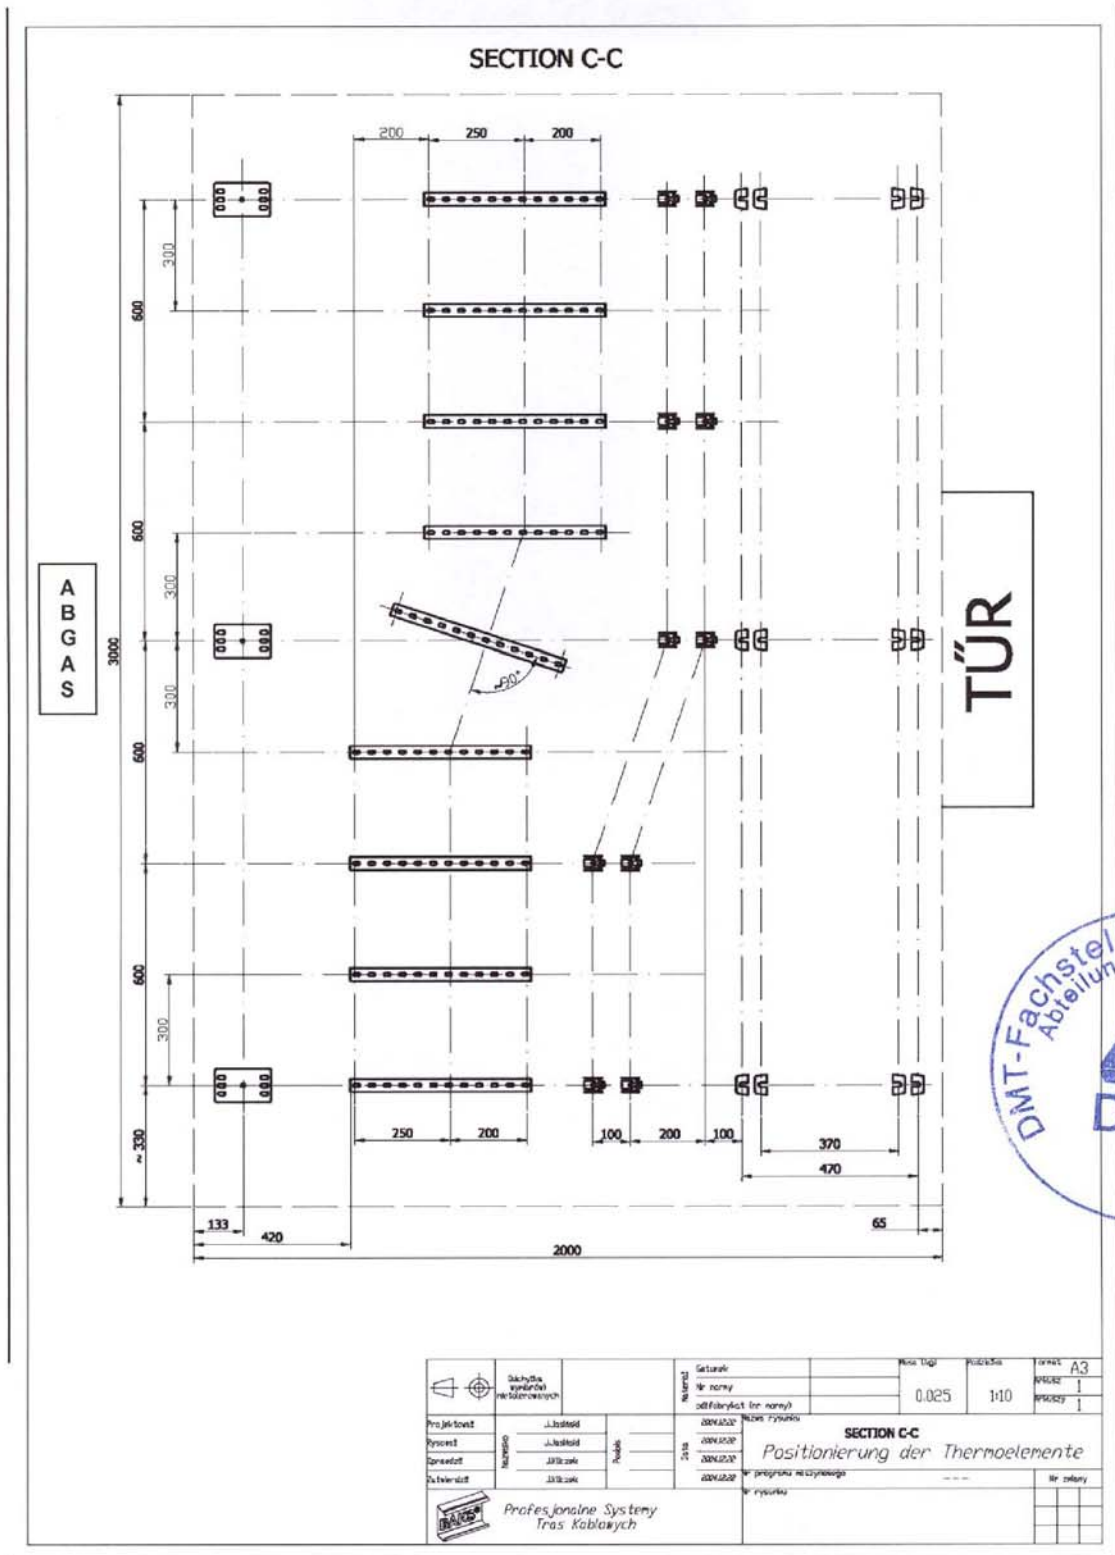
Grundriss der montierten Tragsysteme
